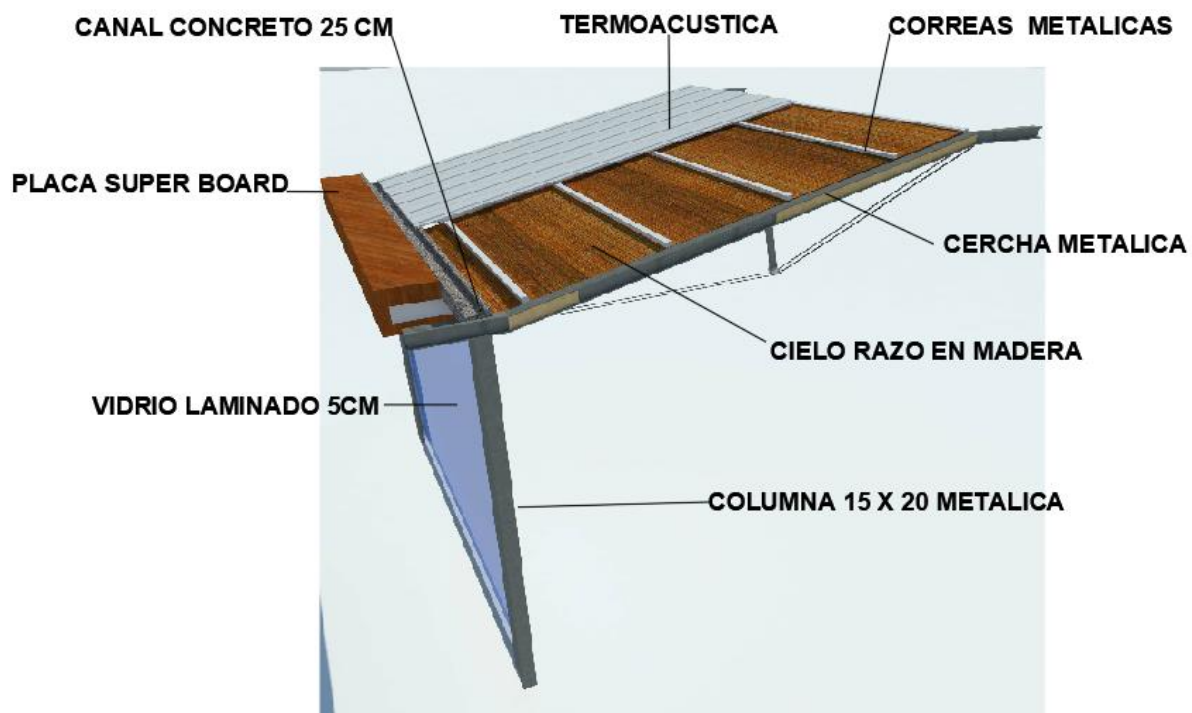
Detalles materiales (Fuente: Elaboración propia)
